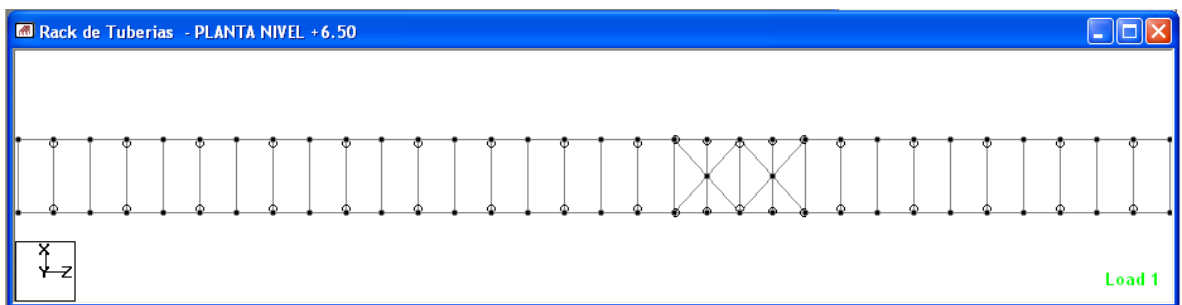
Modelo analítico planta estructural nivel 6.50
